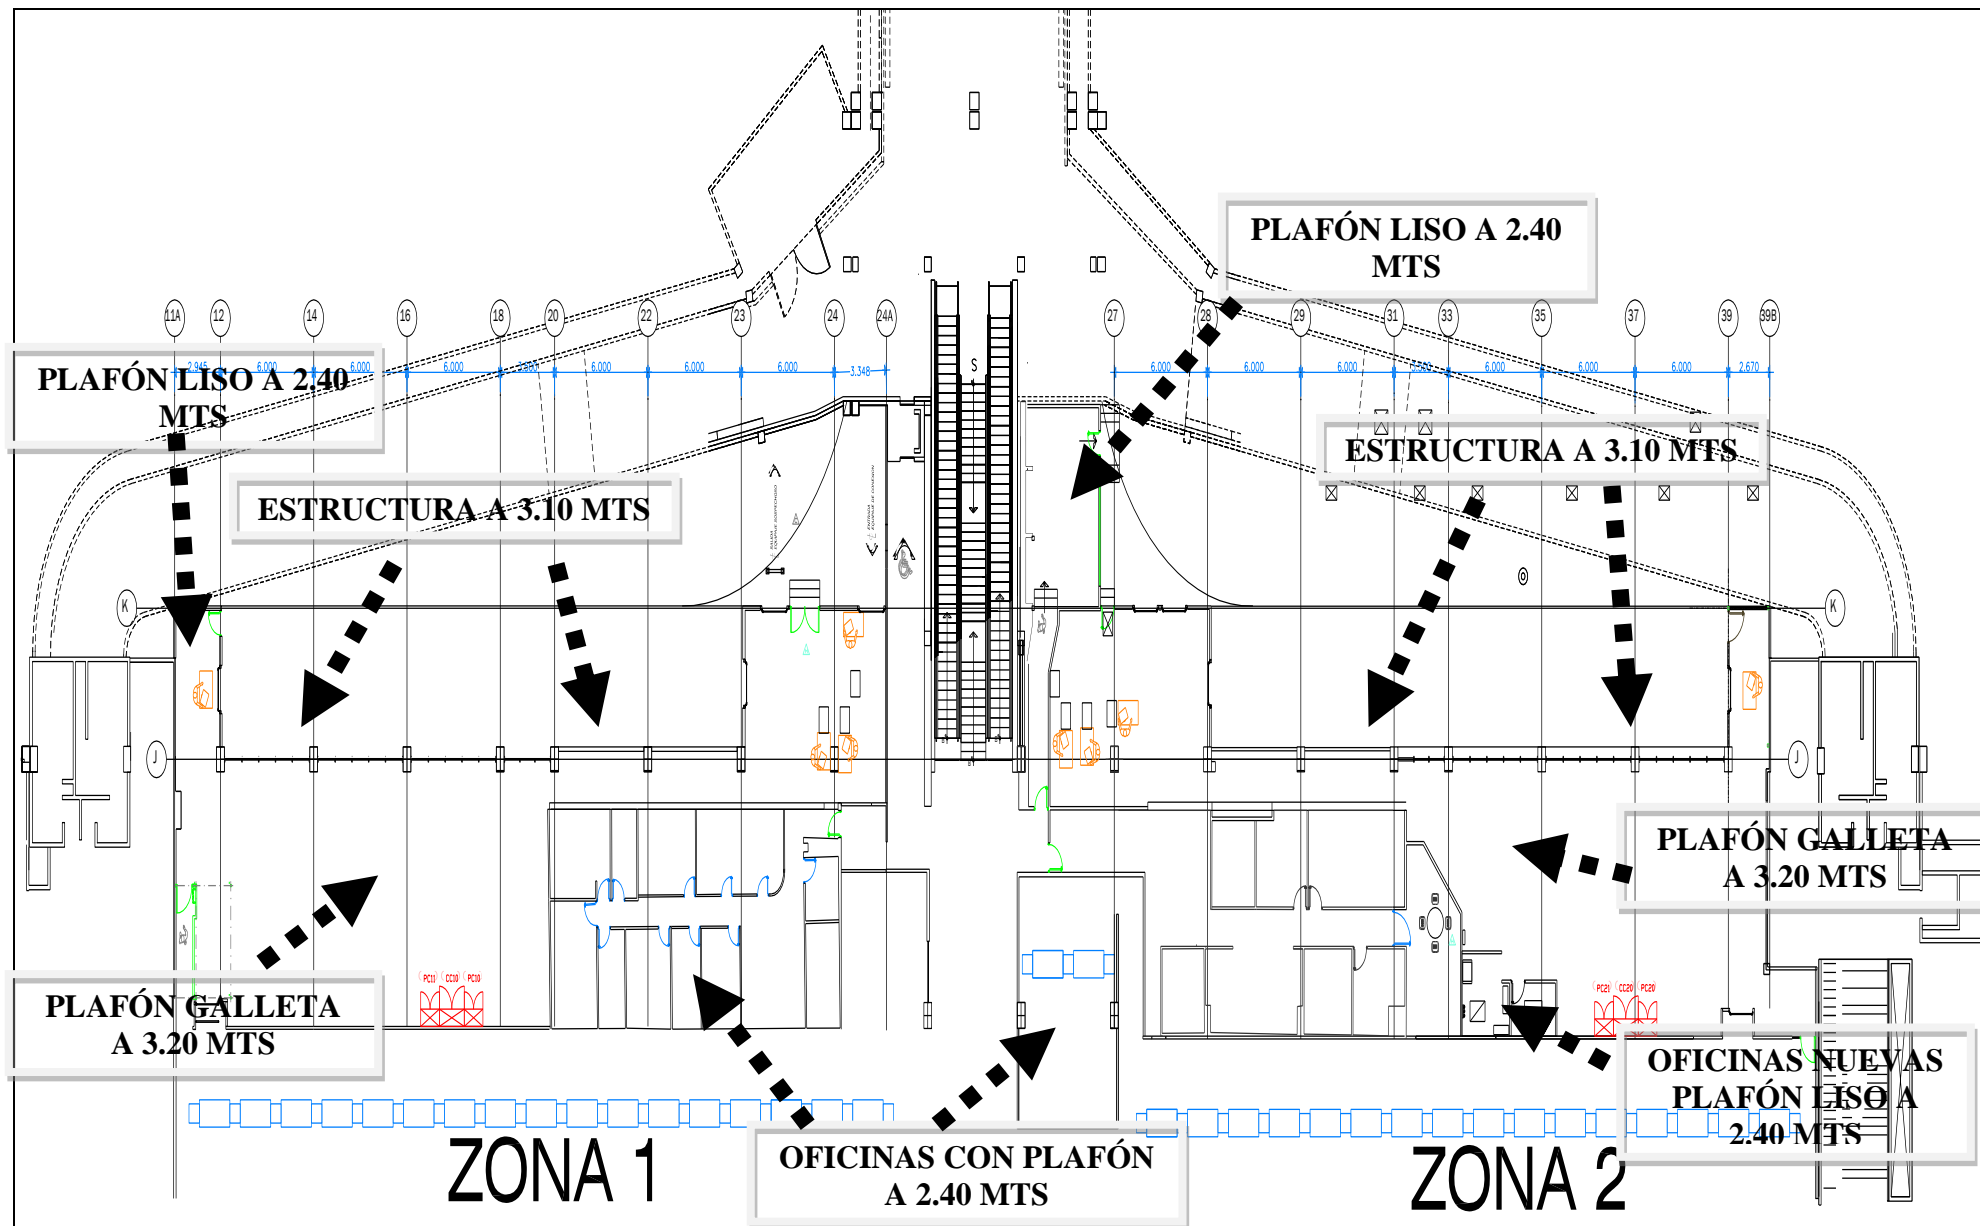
Esquema de alturas de plafón para las zonas en la terminal A (Siemens, 2010)
